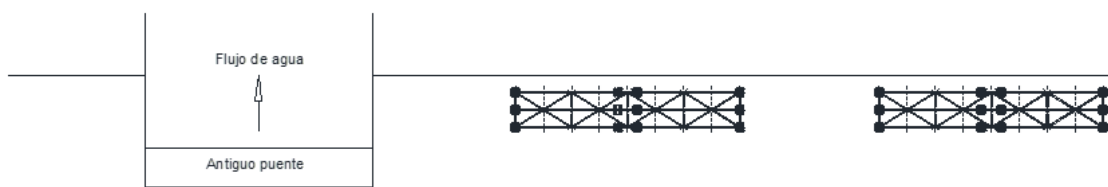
Construcción de vigas metálicas a un costado de la vía
